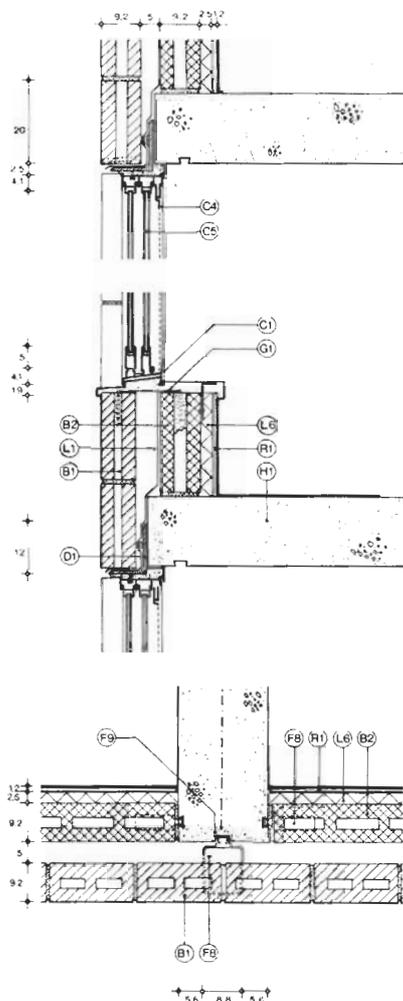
Hoja interior de bloque de hormigón en las viviendas de Roosevelt Island (Sert, Jackson y asociados). Sección por ventana y planta de la unión, fachada muro
